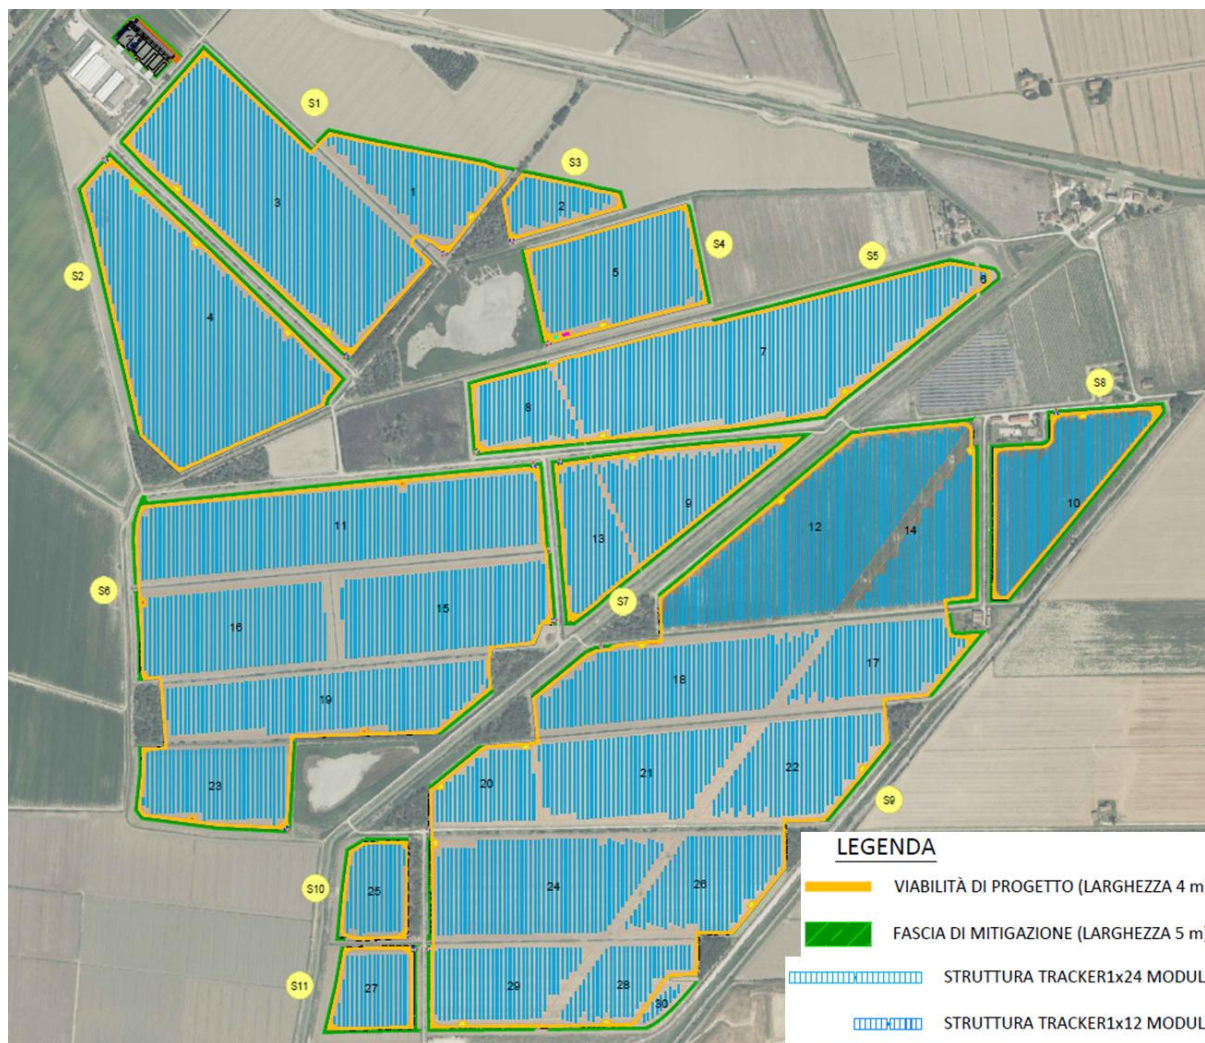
Layout di impianto – Lotto Nord. Fonte: 3342_6955_CNS_T07.2_Rev0_Layout di progetto, Montana, 2026
